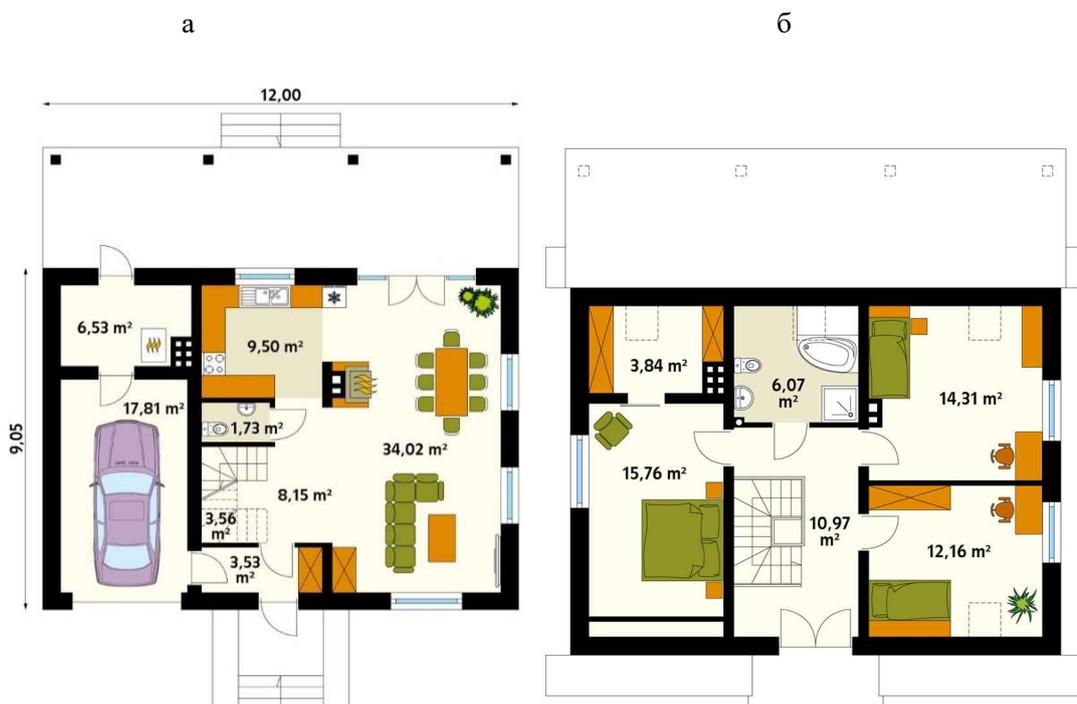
Планы мансардного здания: а – первого этажа; б - мансарды
